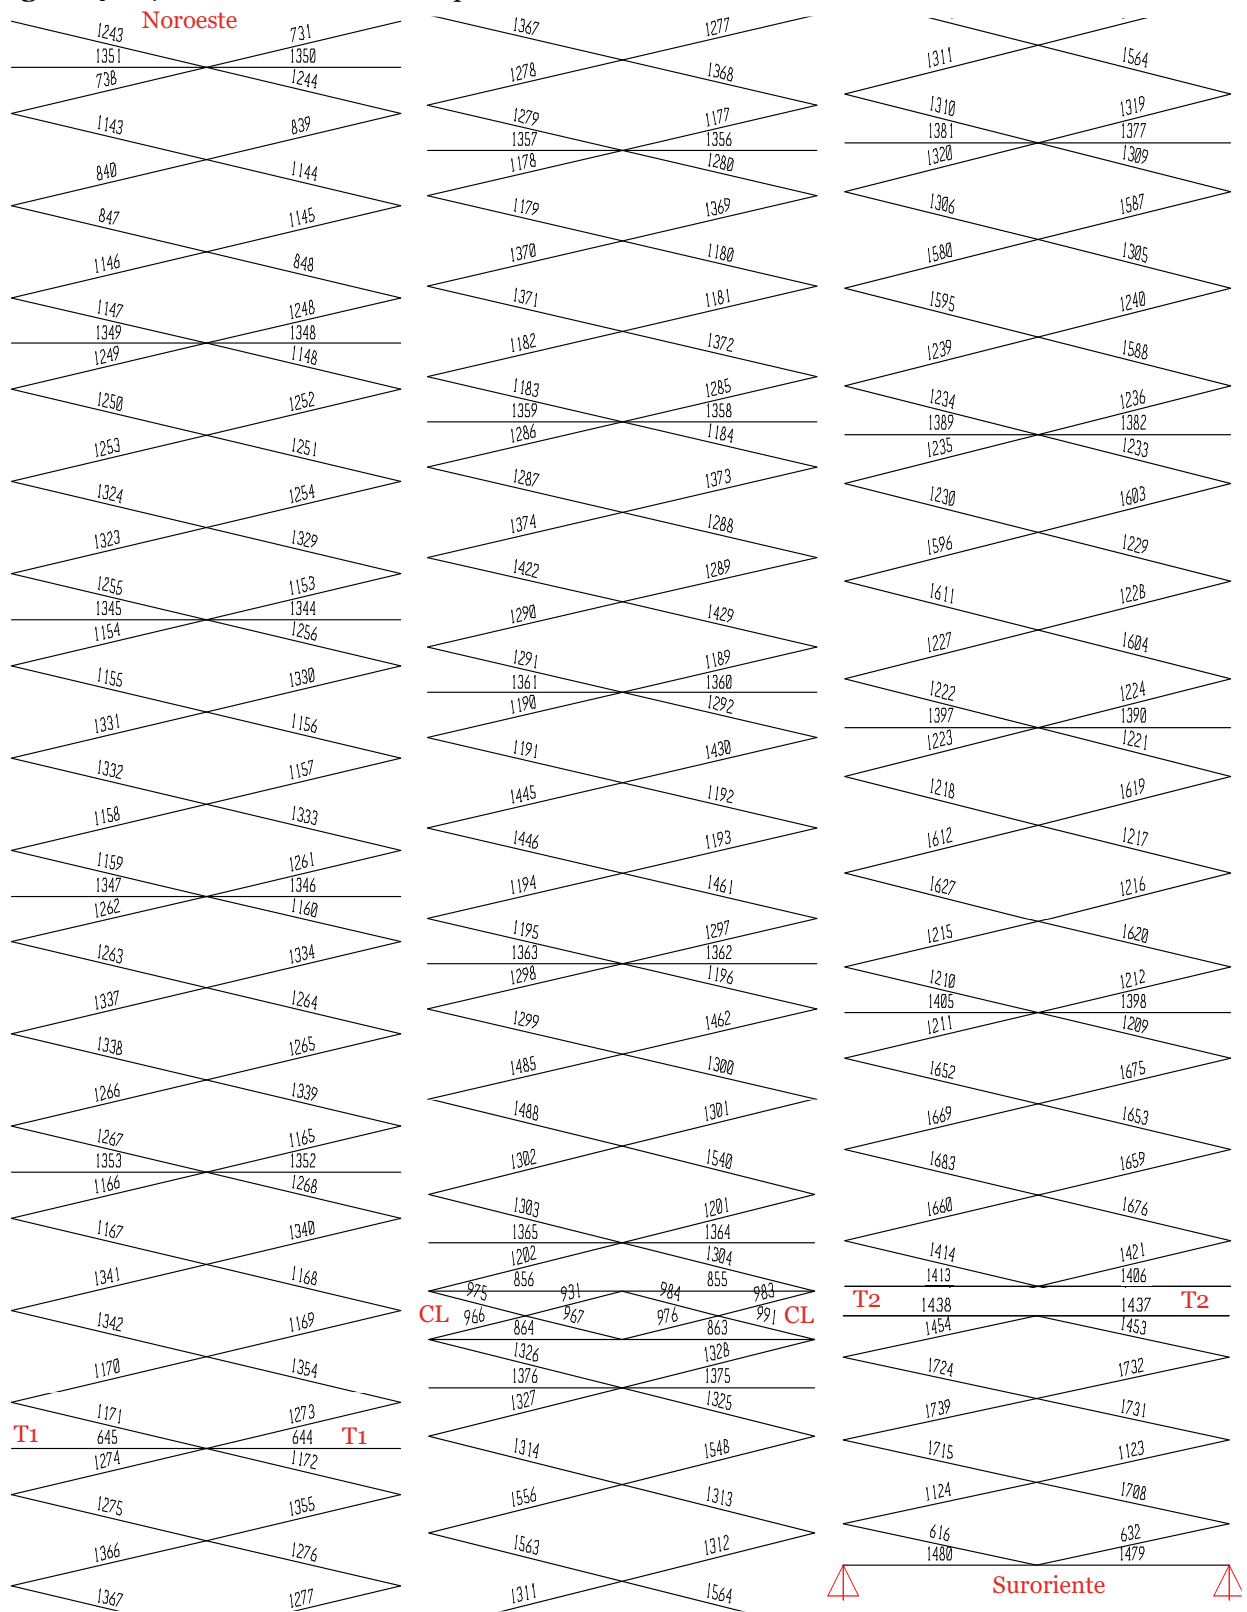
Modelo estructural del puente - Vigas Travesaño.
